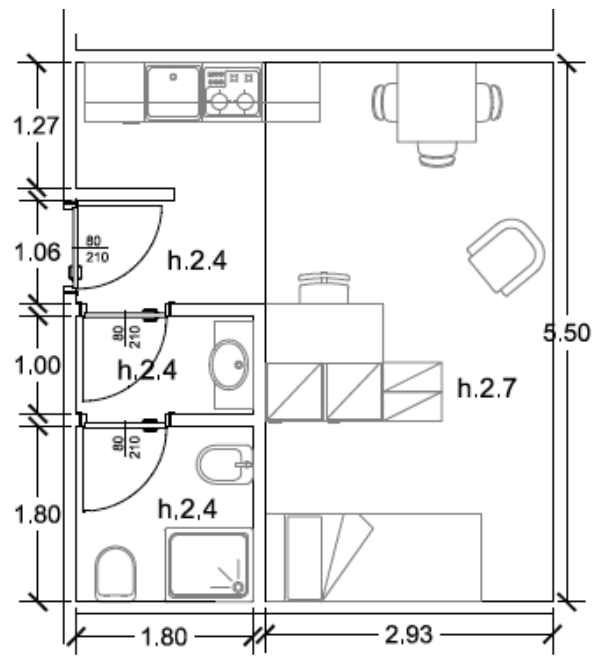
5 – Pianta tipo alloggio in appartamento monocale - Fonte: elaborazione dell'autore
